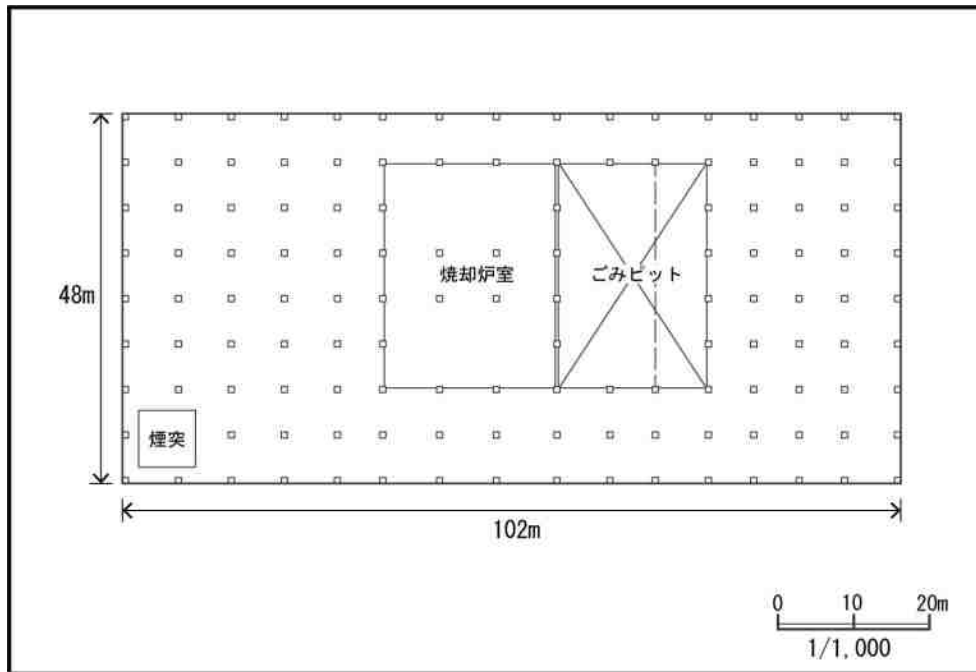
(1) 新施設の平面図（新焼却処理施設地下 1 階）
